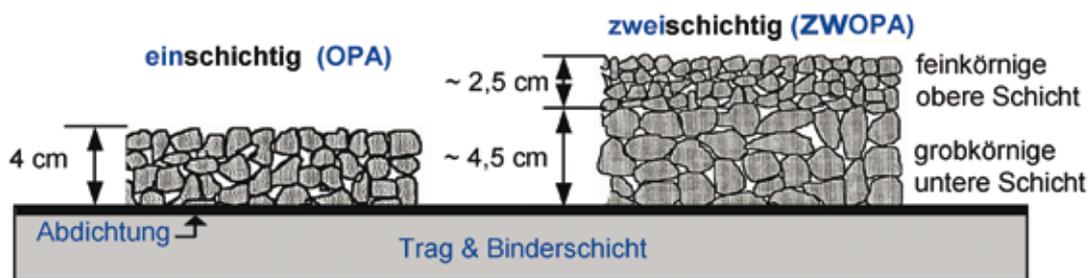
Offenporiger Asphalt – Deckenaufbau
